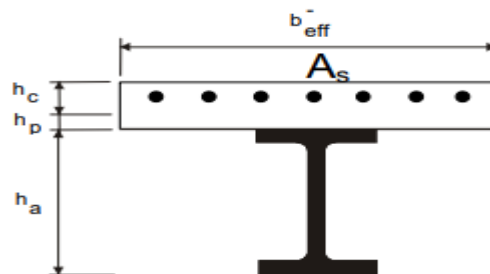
Coupe transversale dalle plancher collaborant avec poutre.
